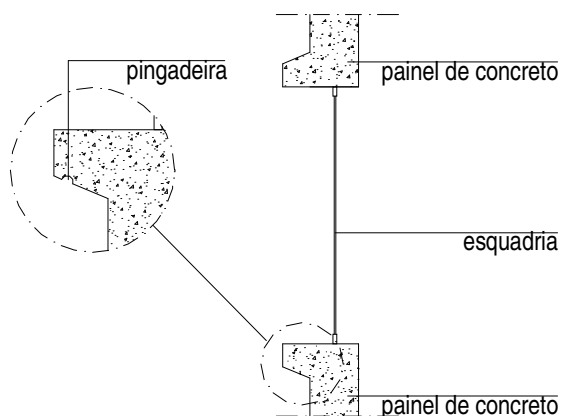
Detalhes construtivos de pingadeiras.
